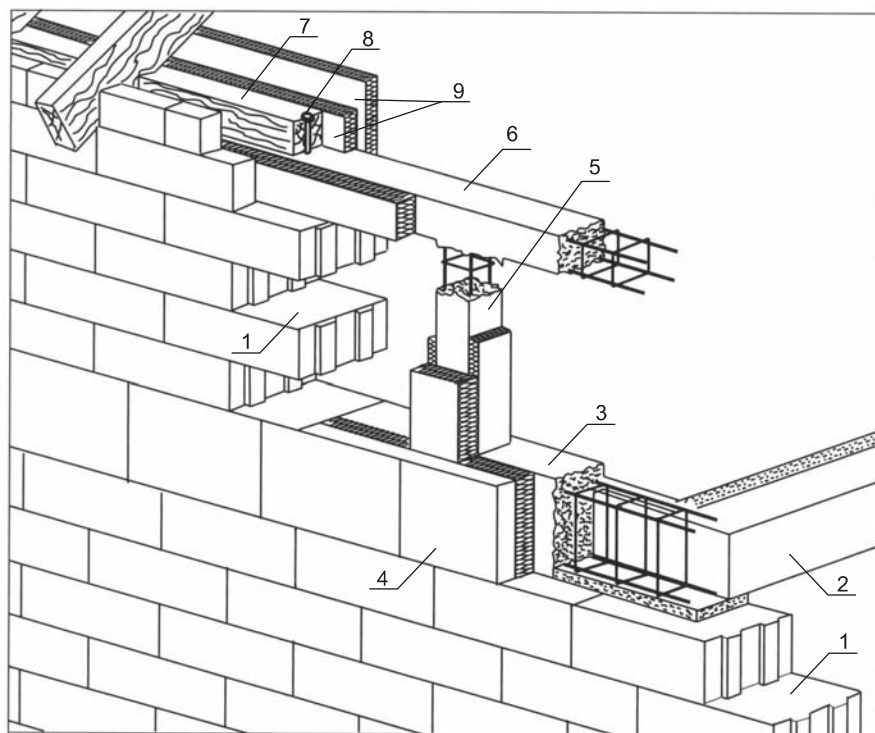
Конструктивная схема фрагмента стены в карнизной части жилого чердачного помещения: 1 — пенобетонные блоки; 2 — перекрытие; 3 — железобетонный пояс жесткости; 4 — облицовка из пенобетонных плит; 5 и 6 — железобетонный усилительный каркас; 7 — мауэрлат; 8 — анкер; 9 — теплоизоляция; 10 — деревянные стропила
